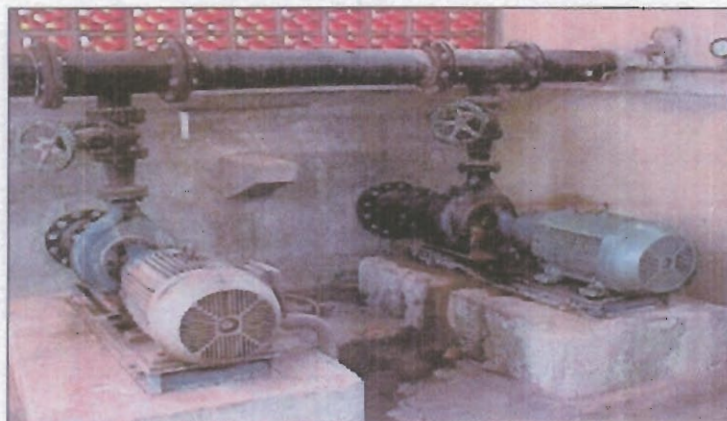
Estação elevatória EEAT02 - Zona Alta
